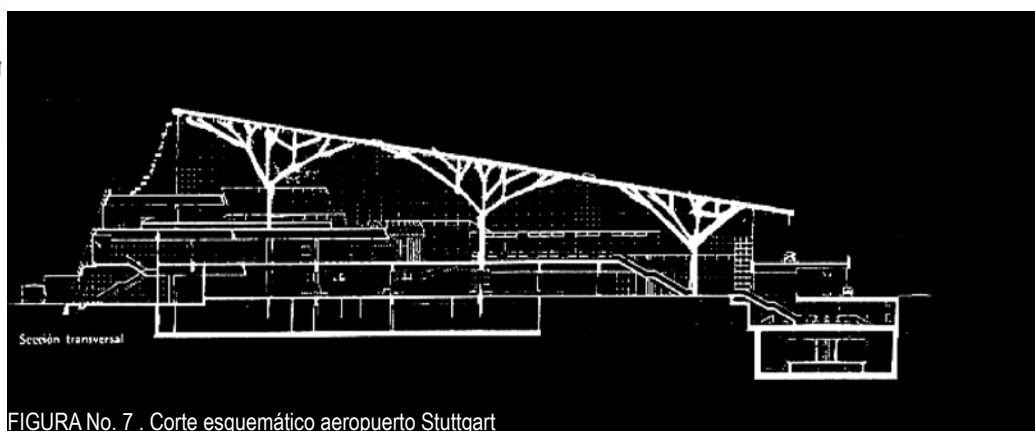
Corte esquemático aeropuerto Stuttgart
